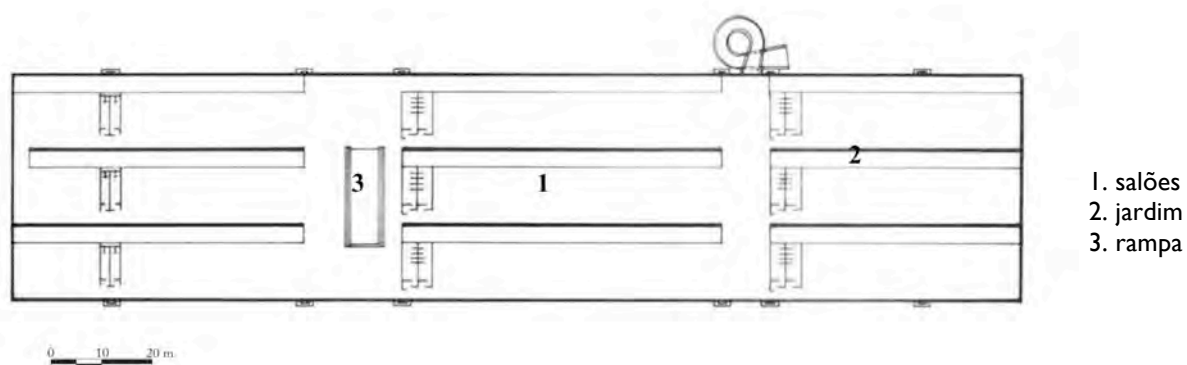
Edifício Castello Branco.(1967) – planta original pavimento superior.
